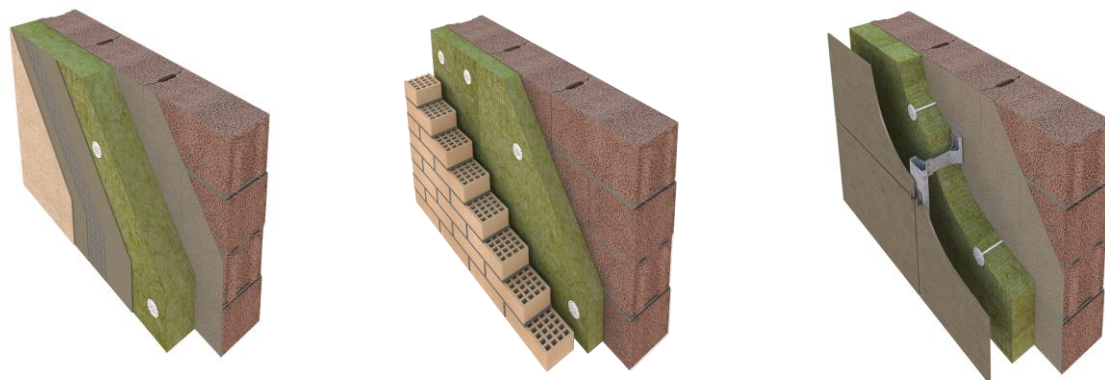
штукатурный фасад, вентилируемый фасад, конструкция с облицовкой
